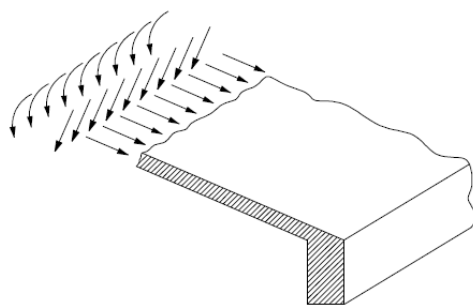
Viga de apoio de uma laje de cobertura inclinada [3].
